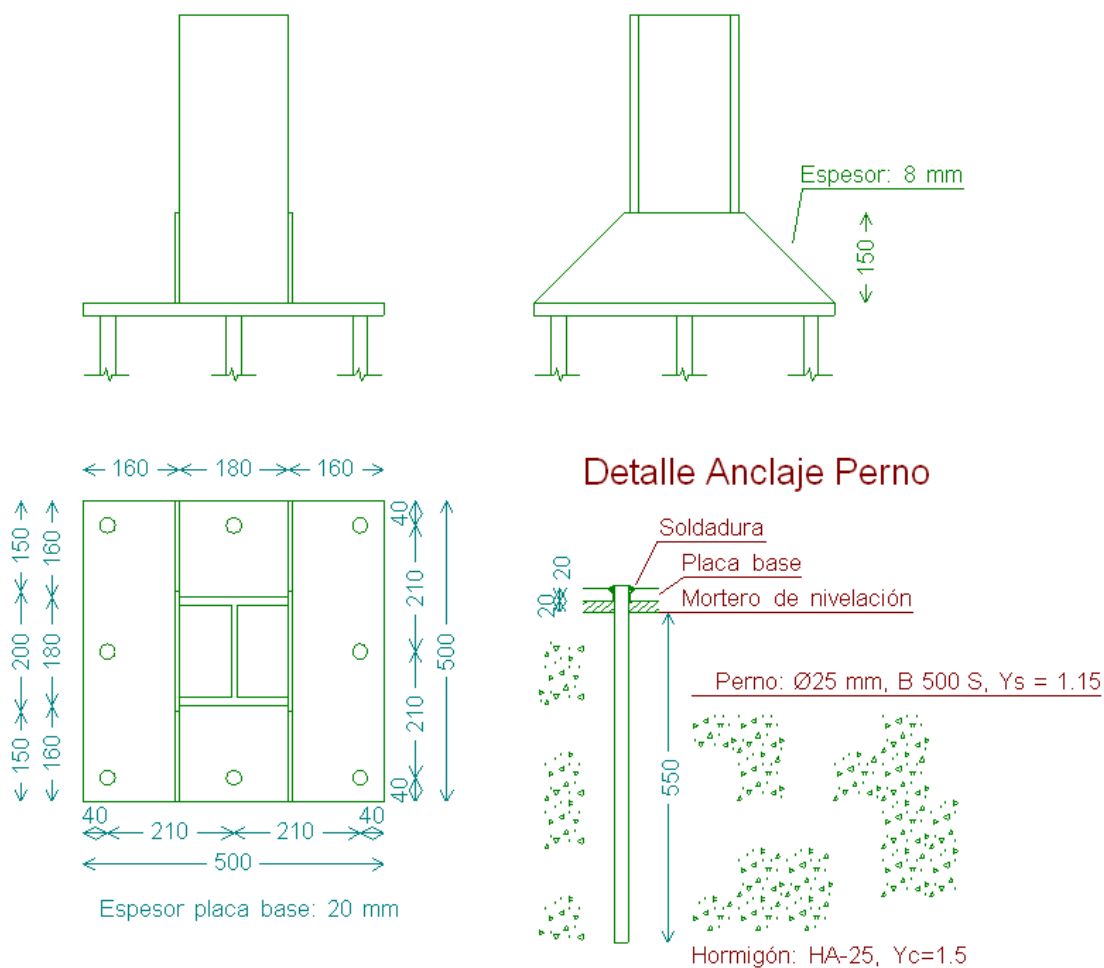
Placas de anclaje de pilares de fachada interiores delantera y trasera
